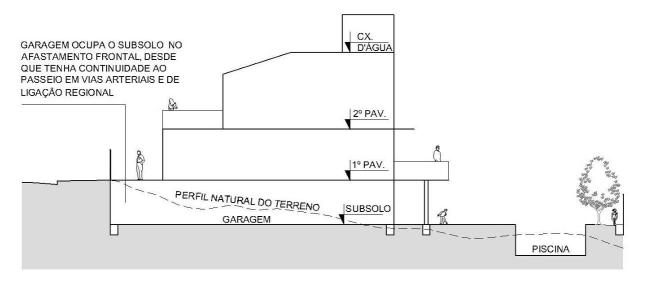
Elemento construtivo no afastamento frontal no terreno em declive: garagem subsolo
